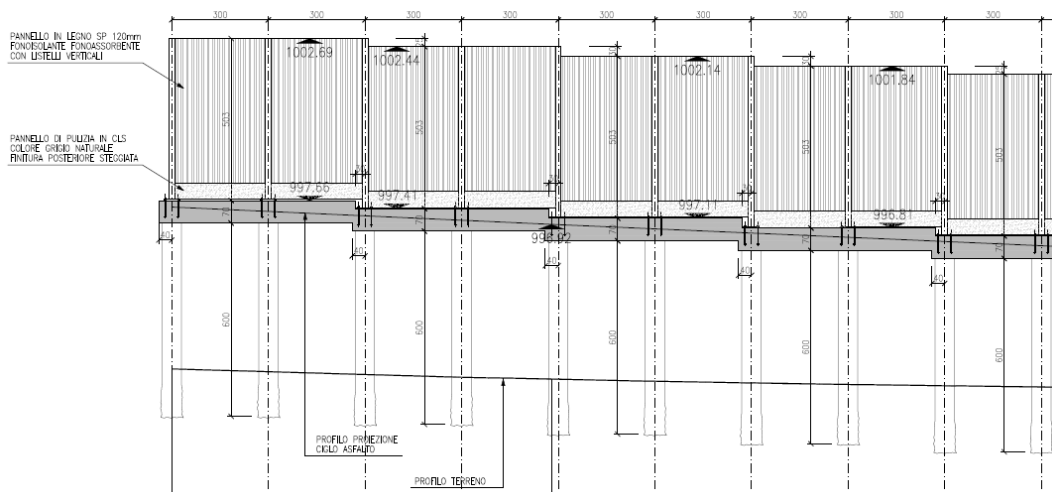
Prospetto caratteristico delle barriere antirumore su rilevato
